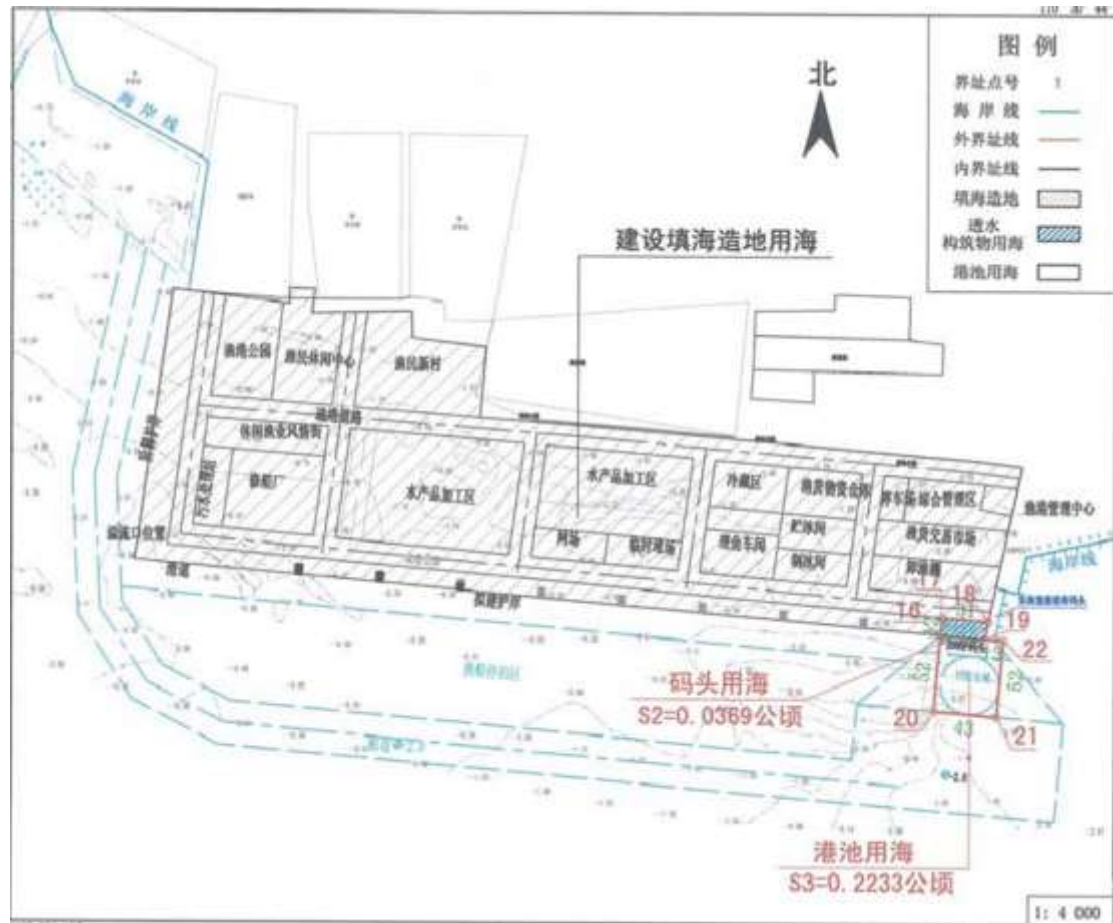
湛江东海岛东南渔港一期工程概况平面布置图
